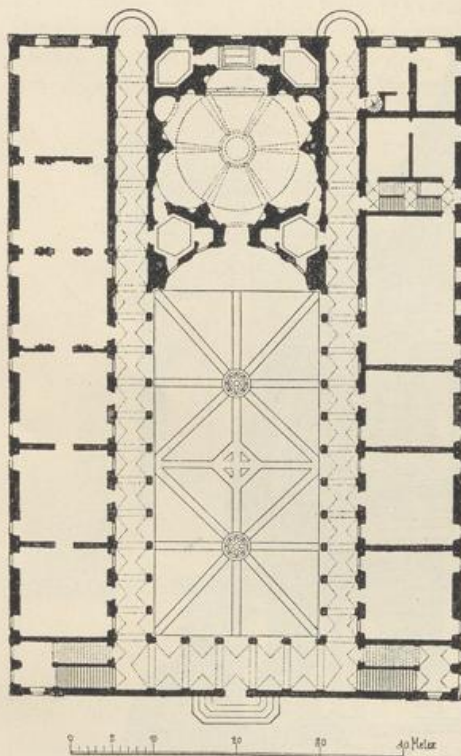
Grundriss der Sapienza zu Rom
